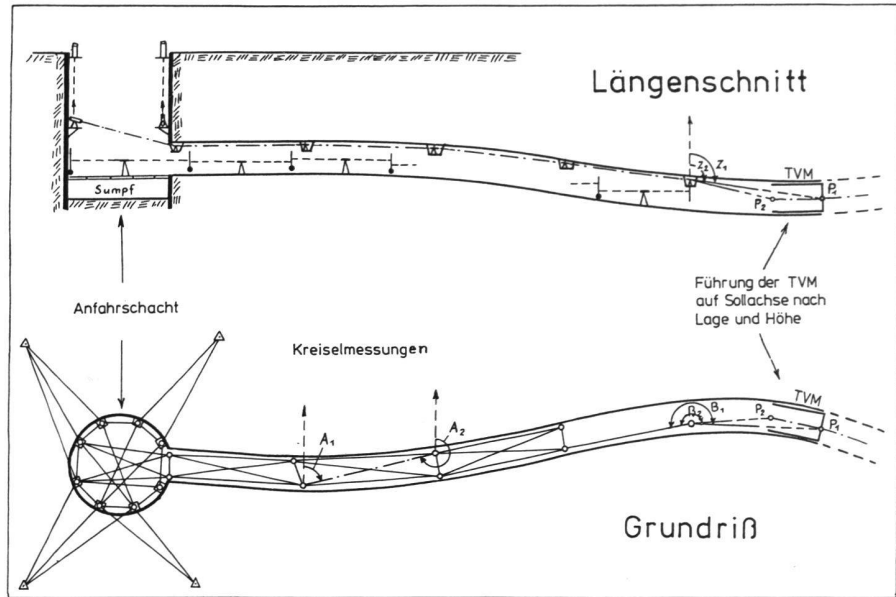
Tunnelfestpunktsystem zur geometrischen Führung der Tunnelvortriebsmaschinen.
